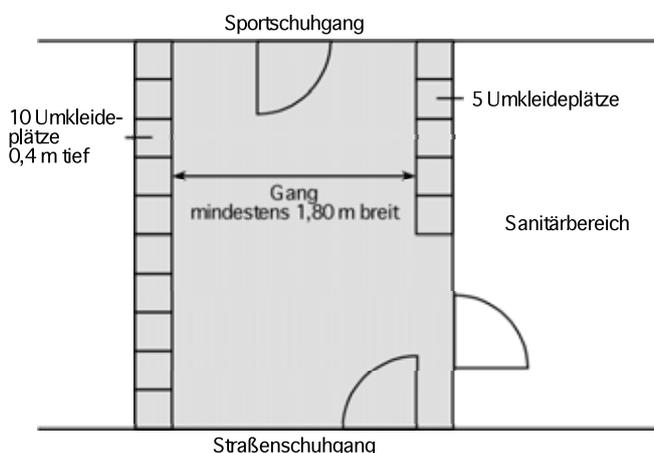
Möglicher Grundriss eines Umkleideraumes mit 15 Plätzen
